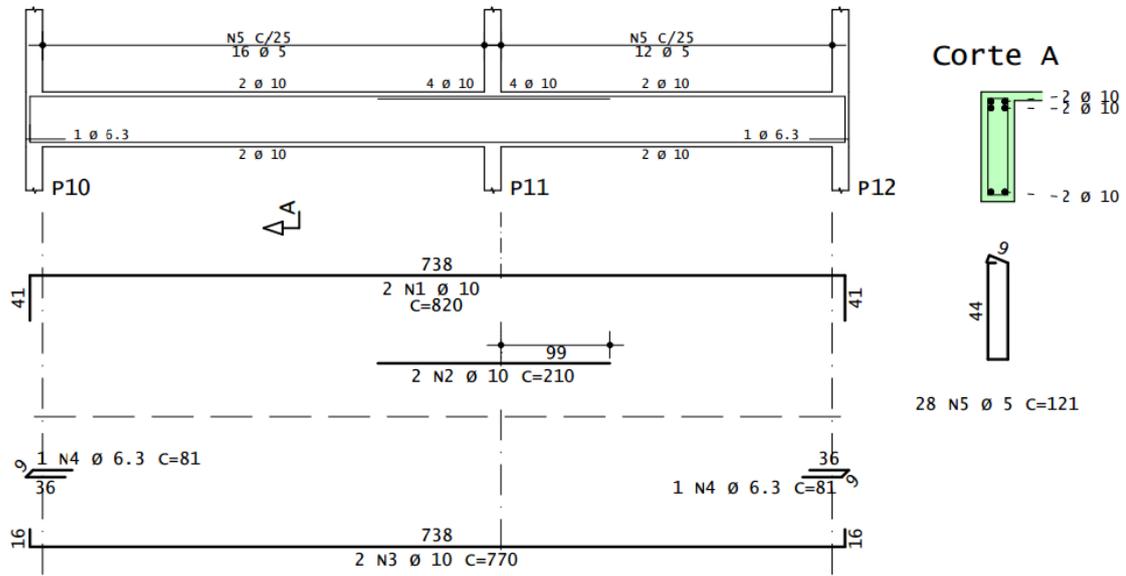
Armadura da viga V5 – pavimento superior (nível +3,00)
